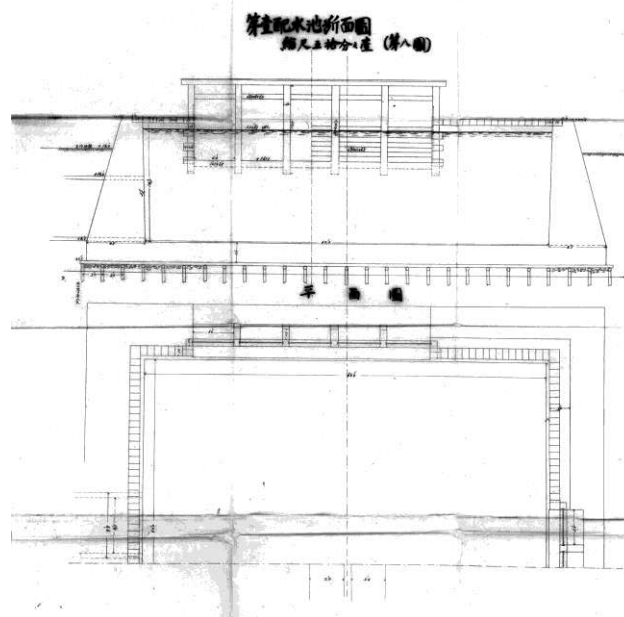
第1次（当初案）における第一配水池の断面図及び平面図
